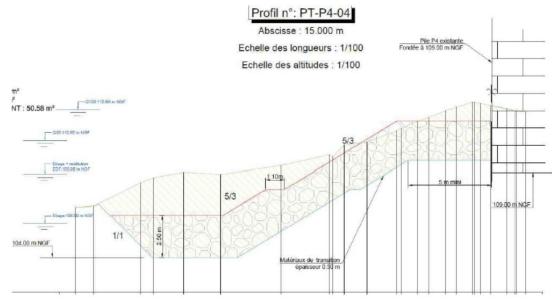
Coupe-type des protections – pile P4 (setec Hydratec)
